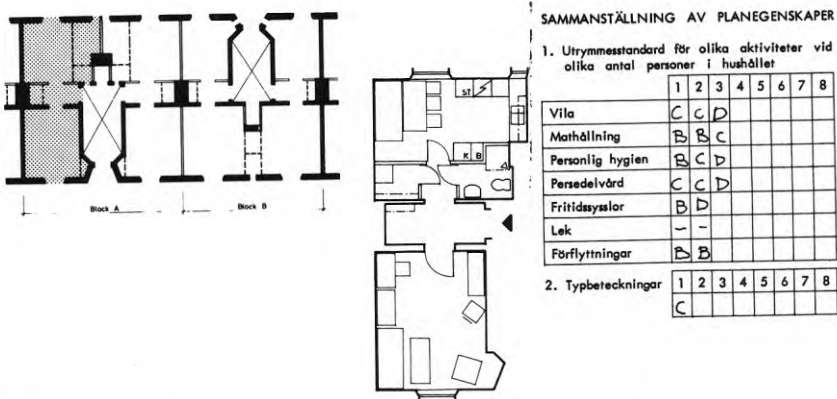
8. Planlösning med lägenhetsytan 42 m<sup>2</sup>.
